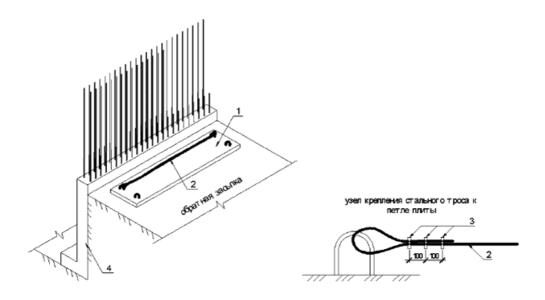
Армирование второго (вышележащего) яруса подпорной стены:
